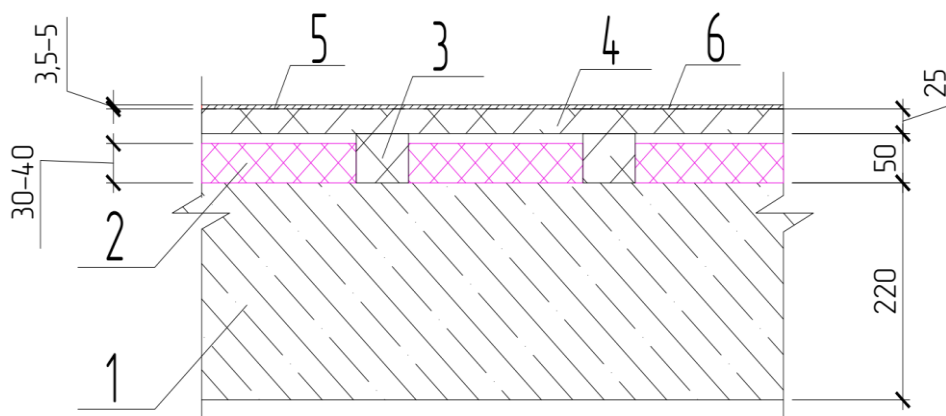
Конструкция перекрытия над неотапливаемым подвалом с применением вакуумных панелей: 1 – плита перекрытия 220 мм; 2 – вакуумная панель 30 – 40 мм; 3 – лаги; 4 – фанера/дощатые полы 25 мм; 5 – подложка вспененная 1 слой; 6 – пол (щиты паркетные) 3,5-5 мм.
